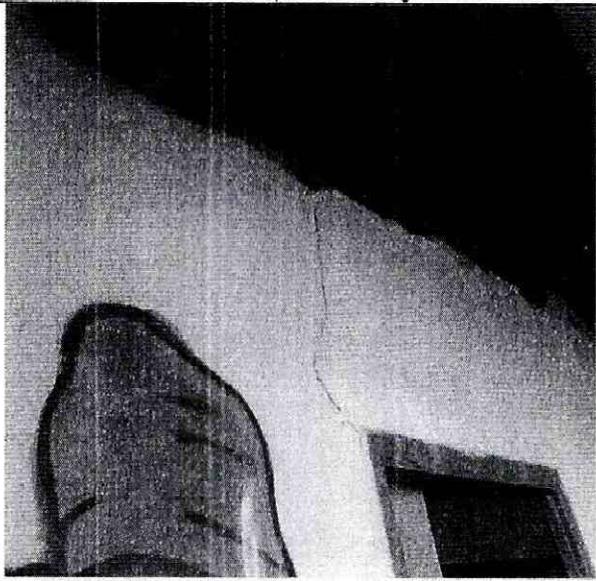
Grieta en parte alta del muro, segundo nivel.
